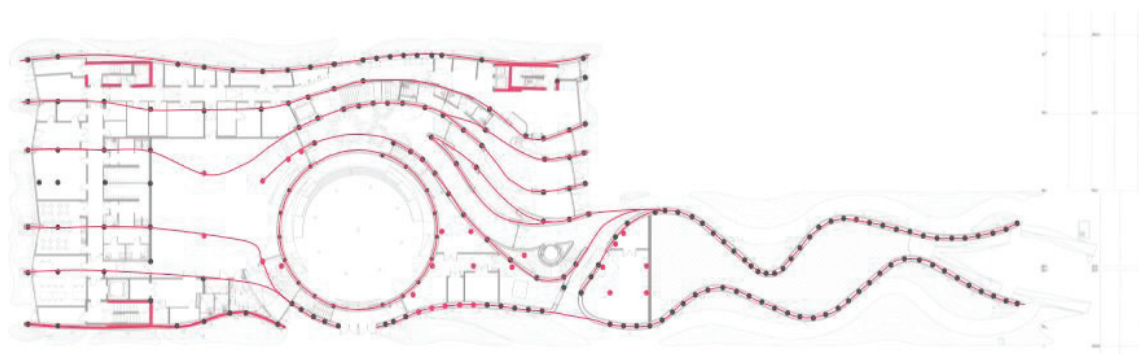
Diagrama estrutural com indicação dos pilares e vigas principais
